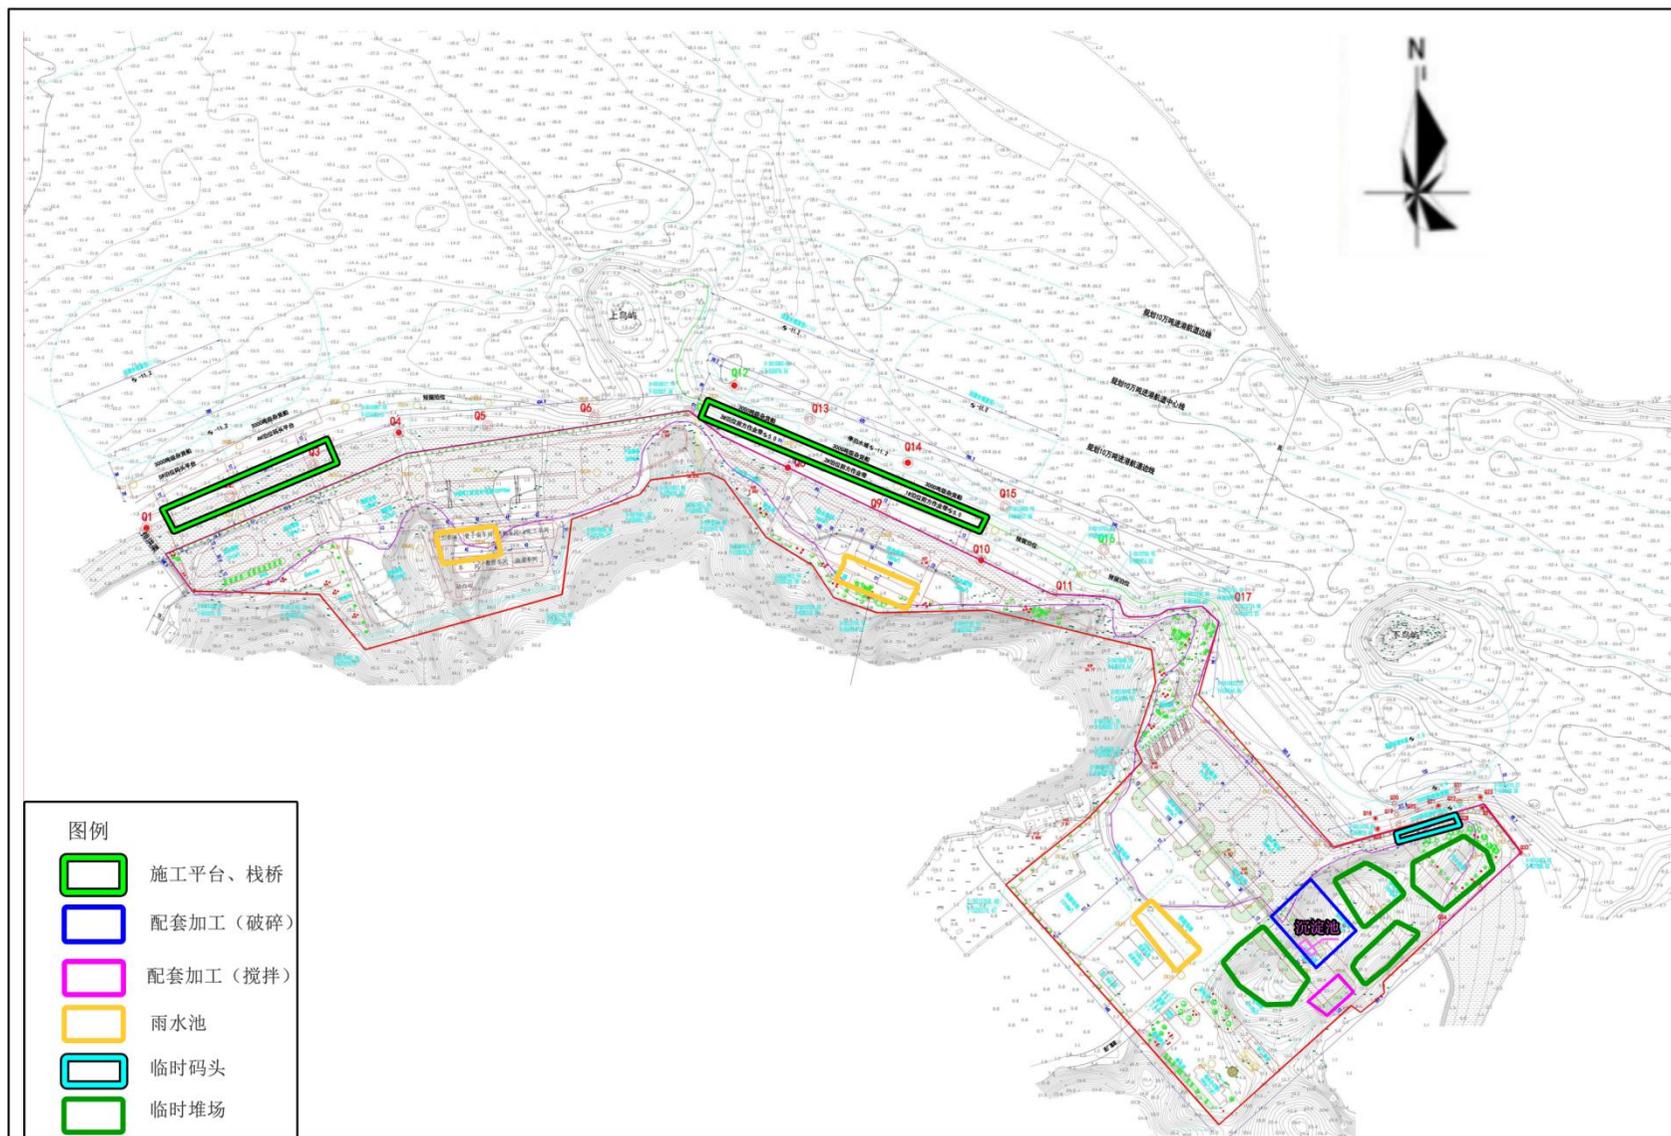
施工平面布置图（码头施工不在本次评价范围内）
